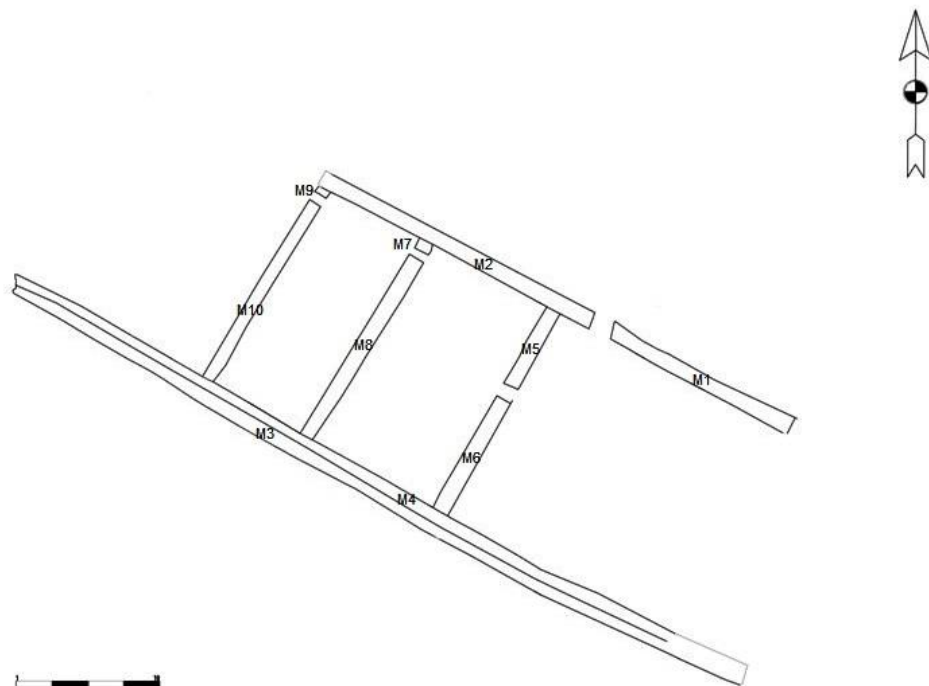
(2).- Fase constructiva 2: planta
